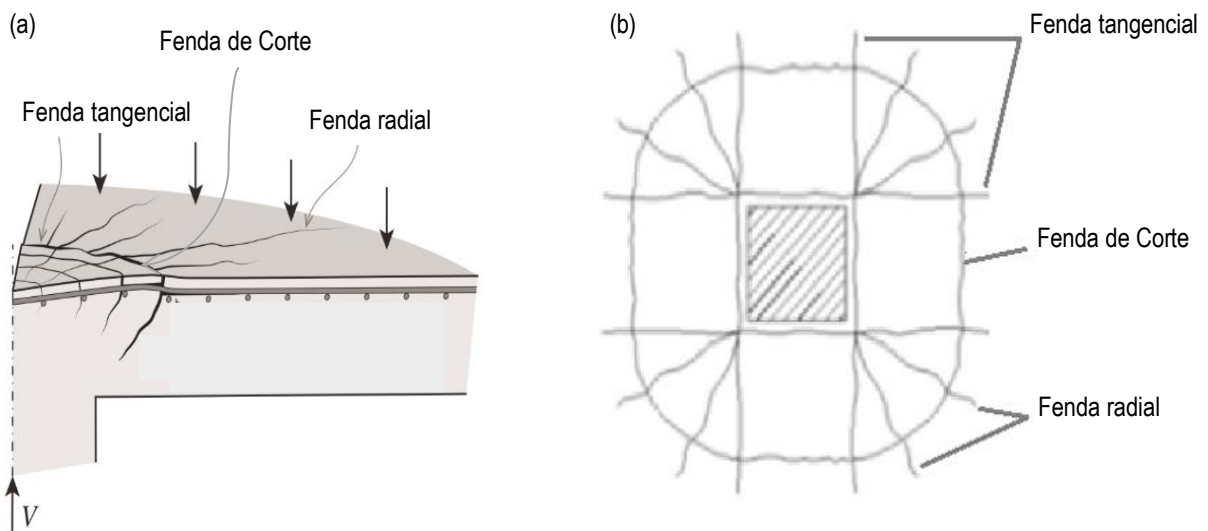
Tipos de Fendilhação presentes no fenómeno do punçoamento: (a) Vista de corte; (b) Vista em planta (adaptado de [12] e [9])
